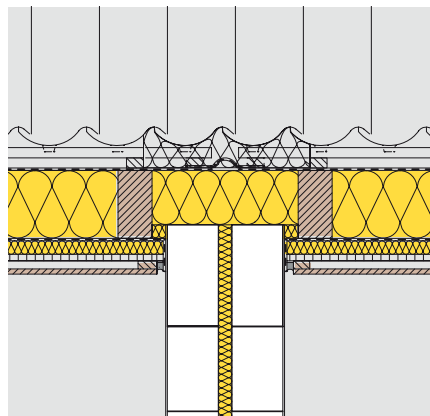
Dachanschluss bei einer zweischaligen Haustrennwand ohne durchlaufende Dachlatten
